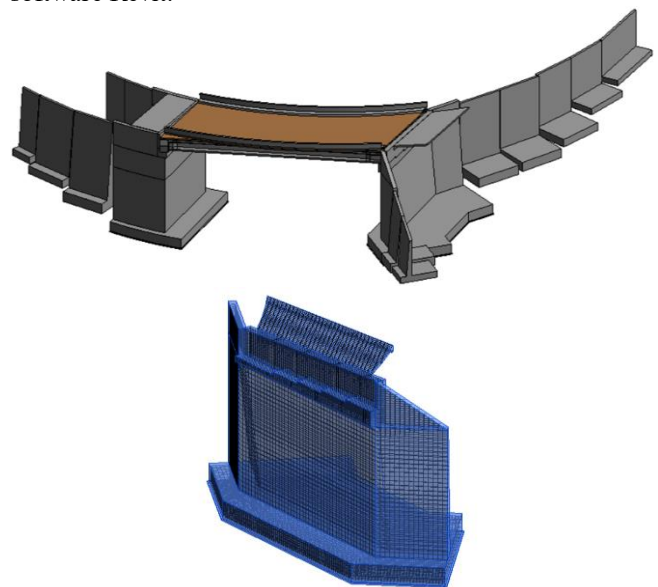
Modelo 3D Estructural y detalle de acero del estribo derecho
